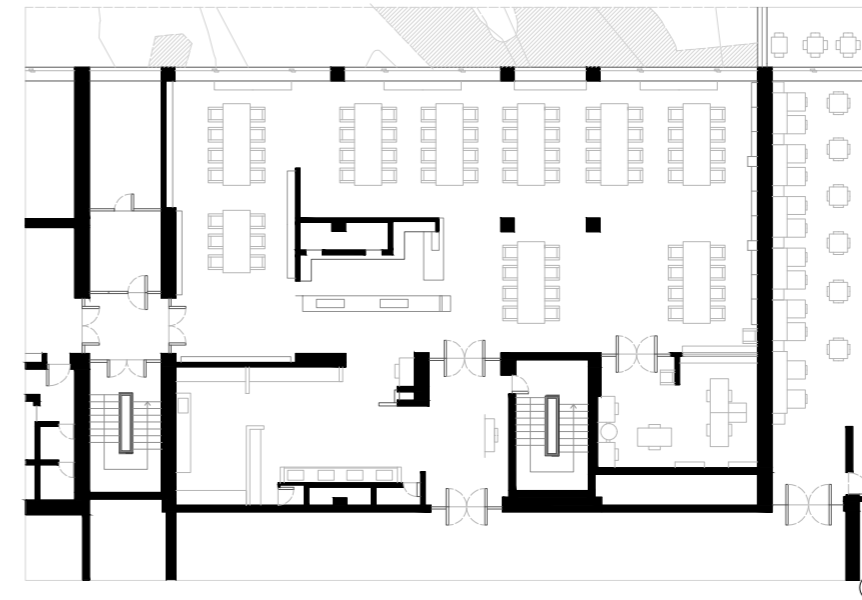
Planta da Sala de Leitura da Biblioteca (Escala 1:300).
